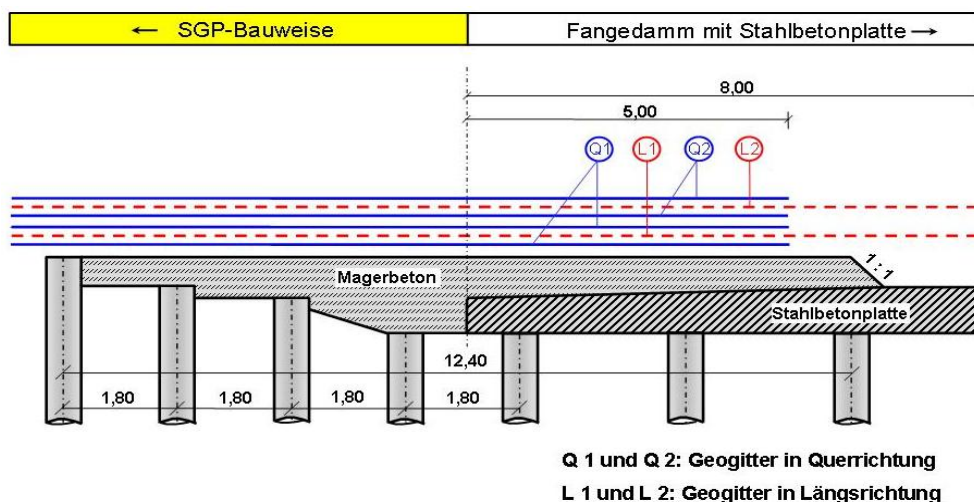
Übergangsbereich zur Stahlbetonplatte (Längsschnitt)
